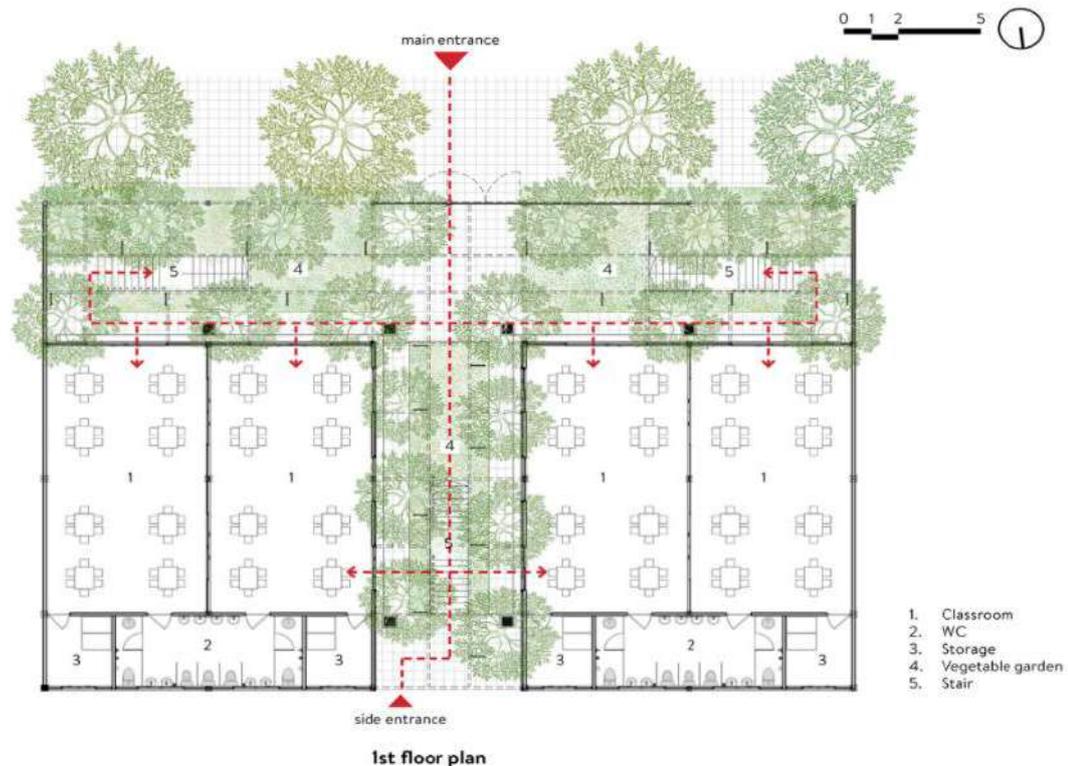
Planta Baja Fuente: Plataforma Arquitectura Elaboración: HGAA
